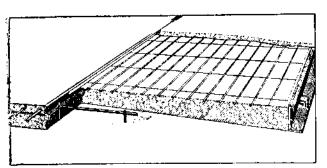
Расположение арматуры и шпунта в железобетонной дорожной плите.
